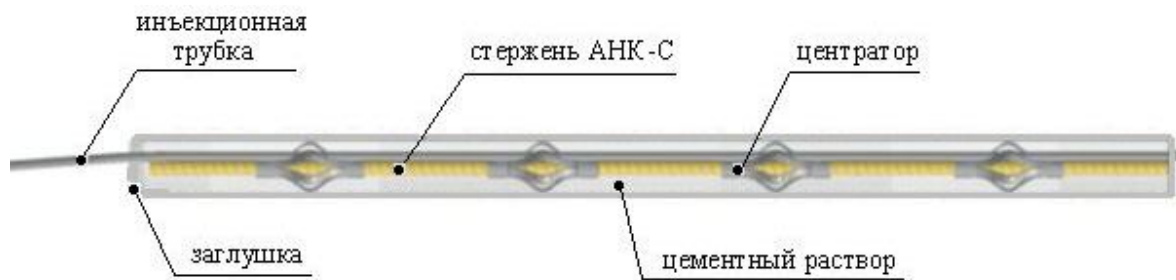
Конструкция армирующего элемента из АНК-С
